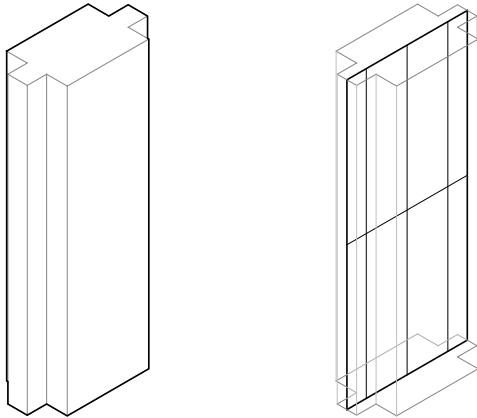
Izq. Modelización de los pilares de planta sótano y baja. [Dibujos del autor]
